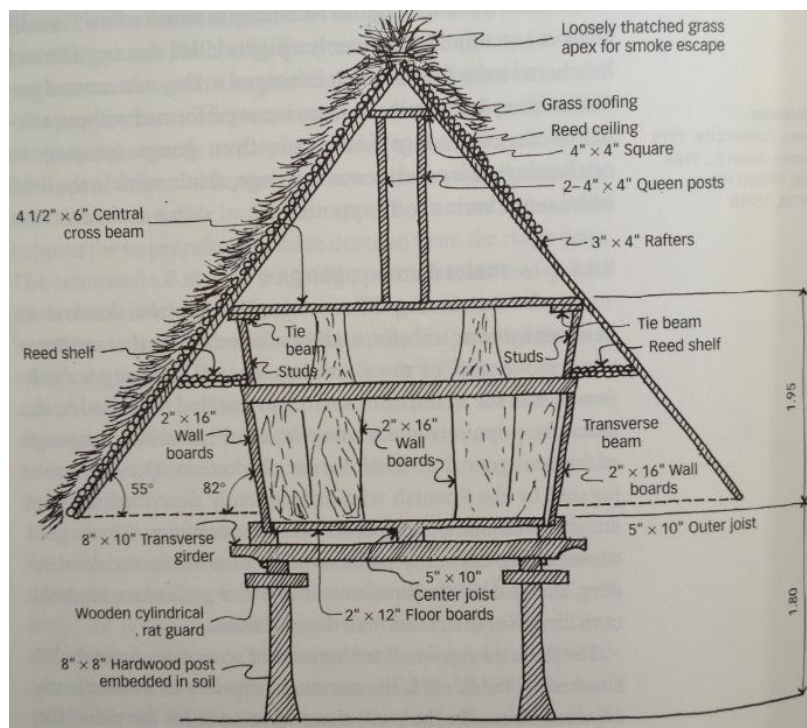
Solução construtiva tradicional utilizando madeira, nas Filipinas [72]
